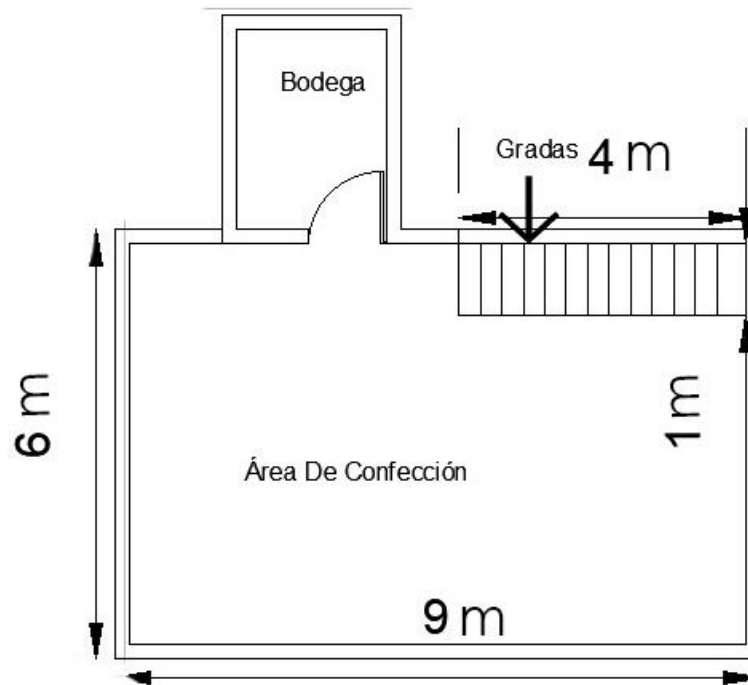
Distribución de las áreas de trabajo de la empresa planta alta.
